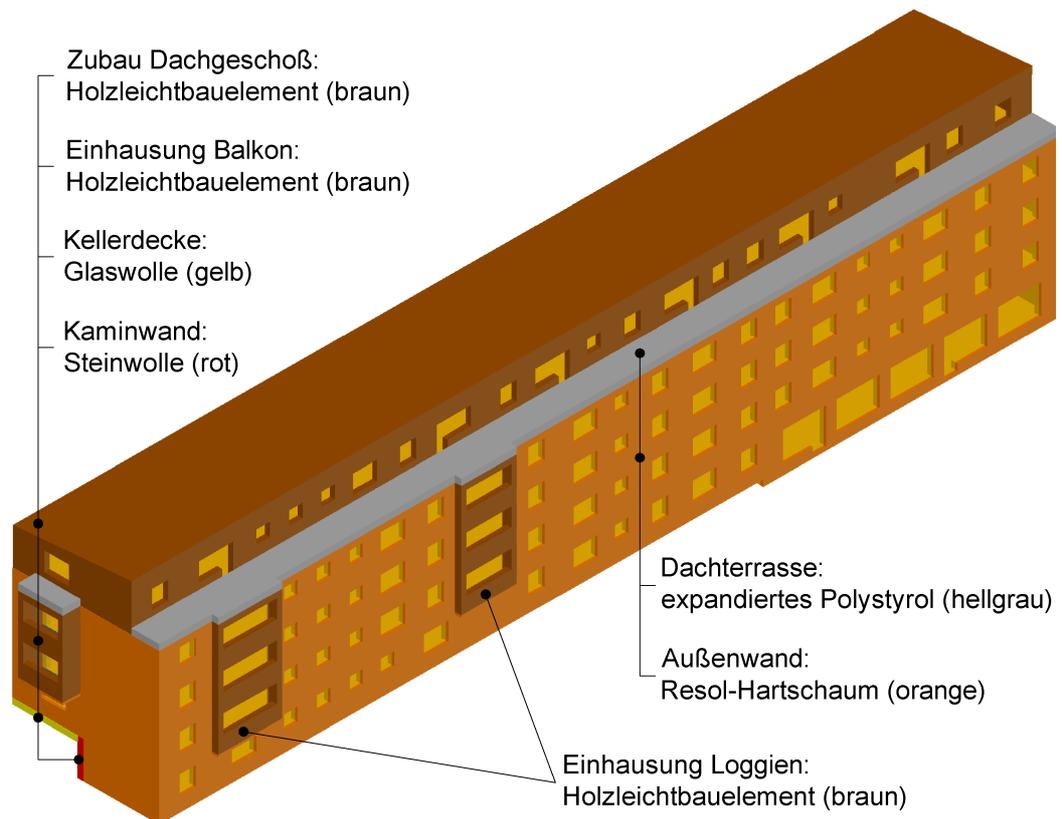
Sanierungsmaßnahmen für die Gebäudeteile der thermischen Gebäudehülle bei der Sanierungsvariante *Passivhaus mit Dachgeschoß
